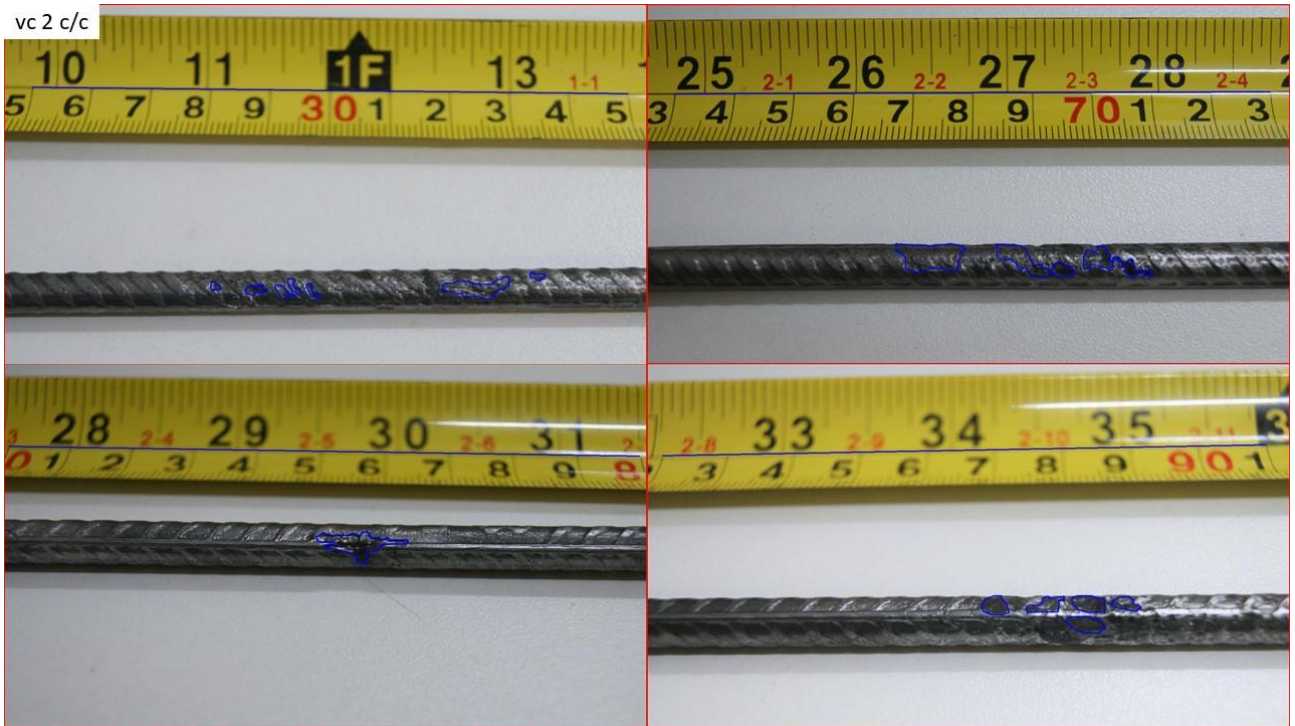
áreas superficiais corroídas do vergalhão da viga vc 2 c/c – parte 1
